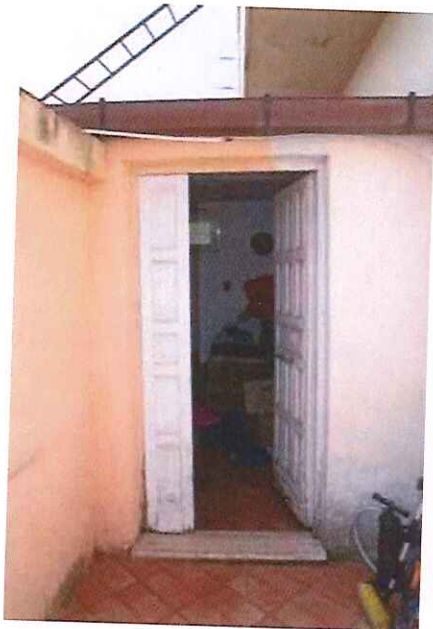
Foto 27 – Lotto 1 – Locale Ripostiglio
